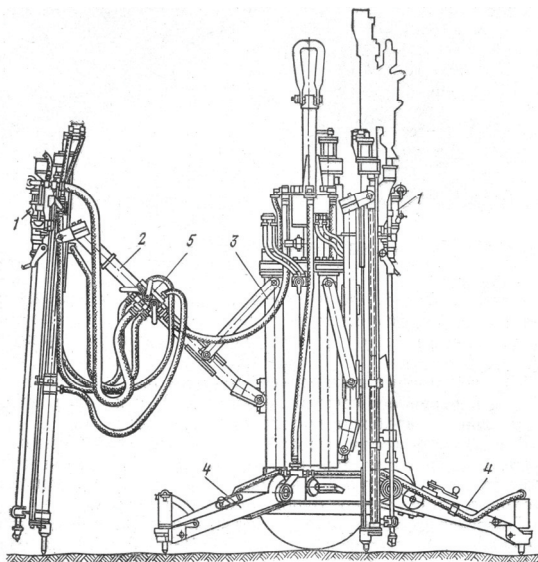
Схема буровой установки БУКС-1м [29]:
